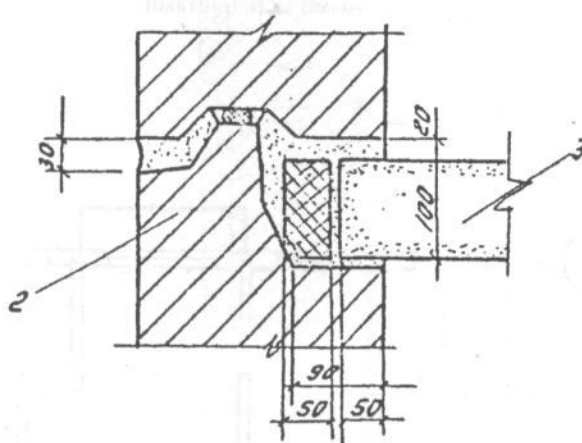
Горизонтальный стык наружных стеновых панелей
